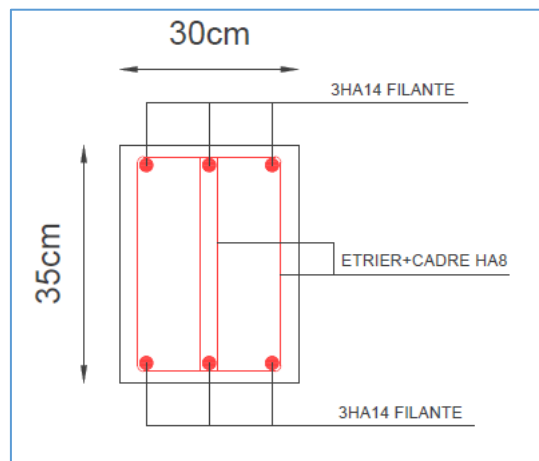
Schéma de ferrailage de la poutre palière.
